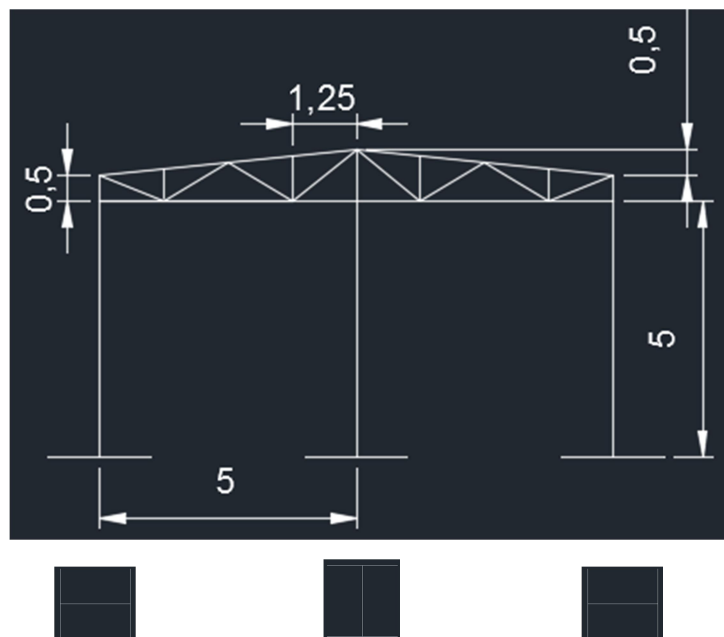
Esquema con las dimensiones del muro hastial y posicionamiento de los pilares
